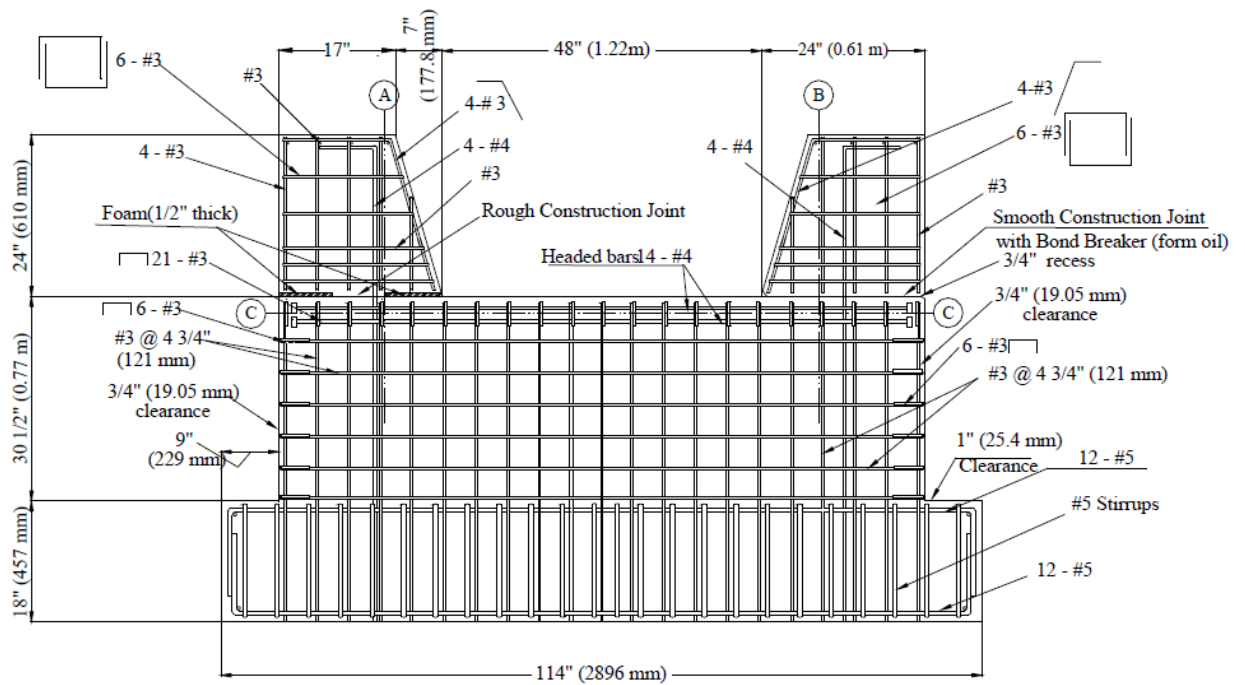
Vista en Elevación de Refuerzos – Serie 5 Externa (Bozorgzadeh et al., 2007).
